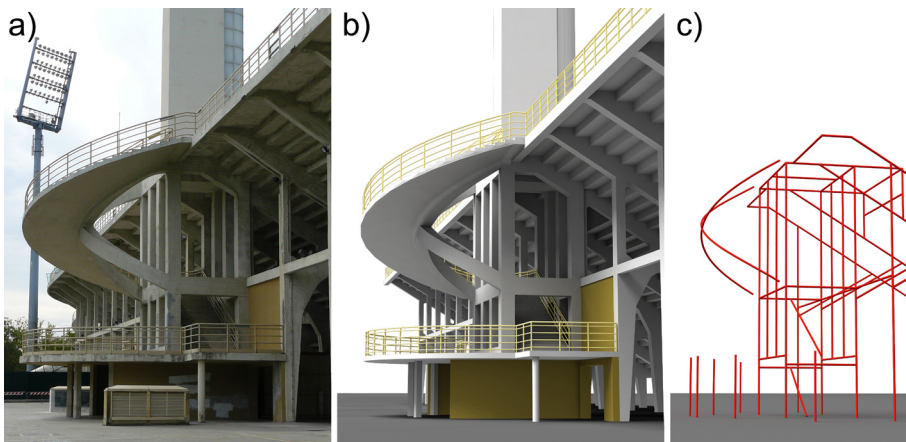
a) Struttura reale, b) restituzione del rilievo in Autocad, c) creazione del modello resistente a elementi finiti di tipo beam.
